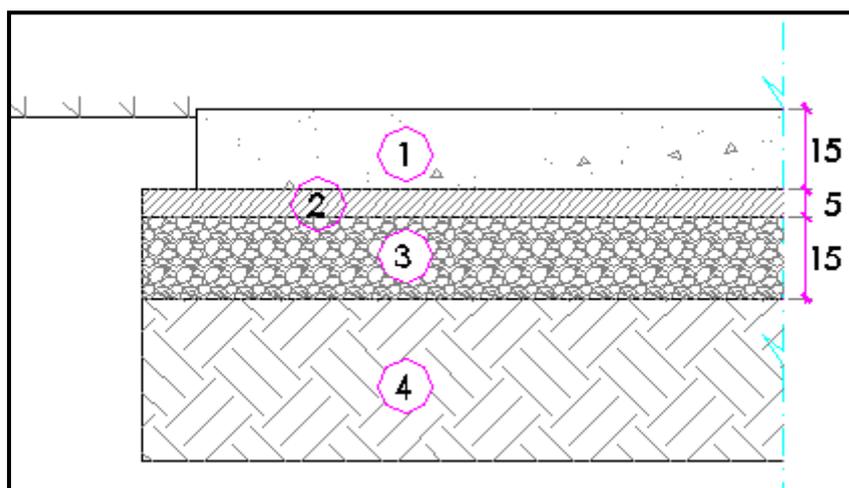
Detalle de la plataforma de hormigón, donde 1=Hormigón HA-25/B/20/IIa y cortado, 2= Hormigón de limpieza HM-20, 3= Zohorra artificial y 4= Pedraplen o terreno natural tratado y compactado.
